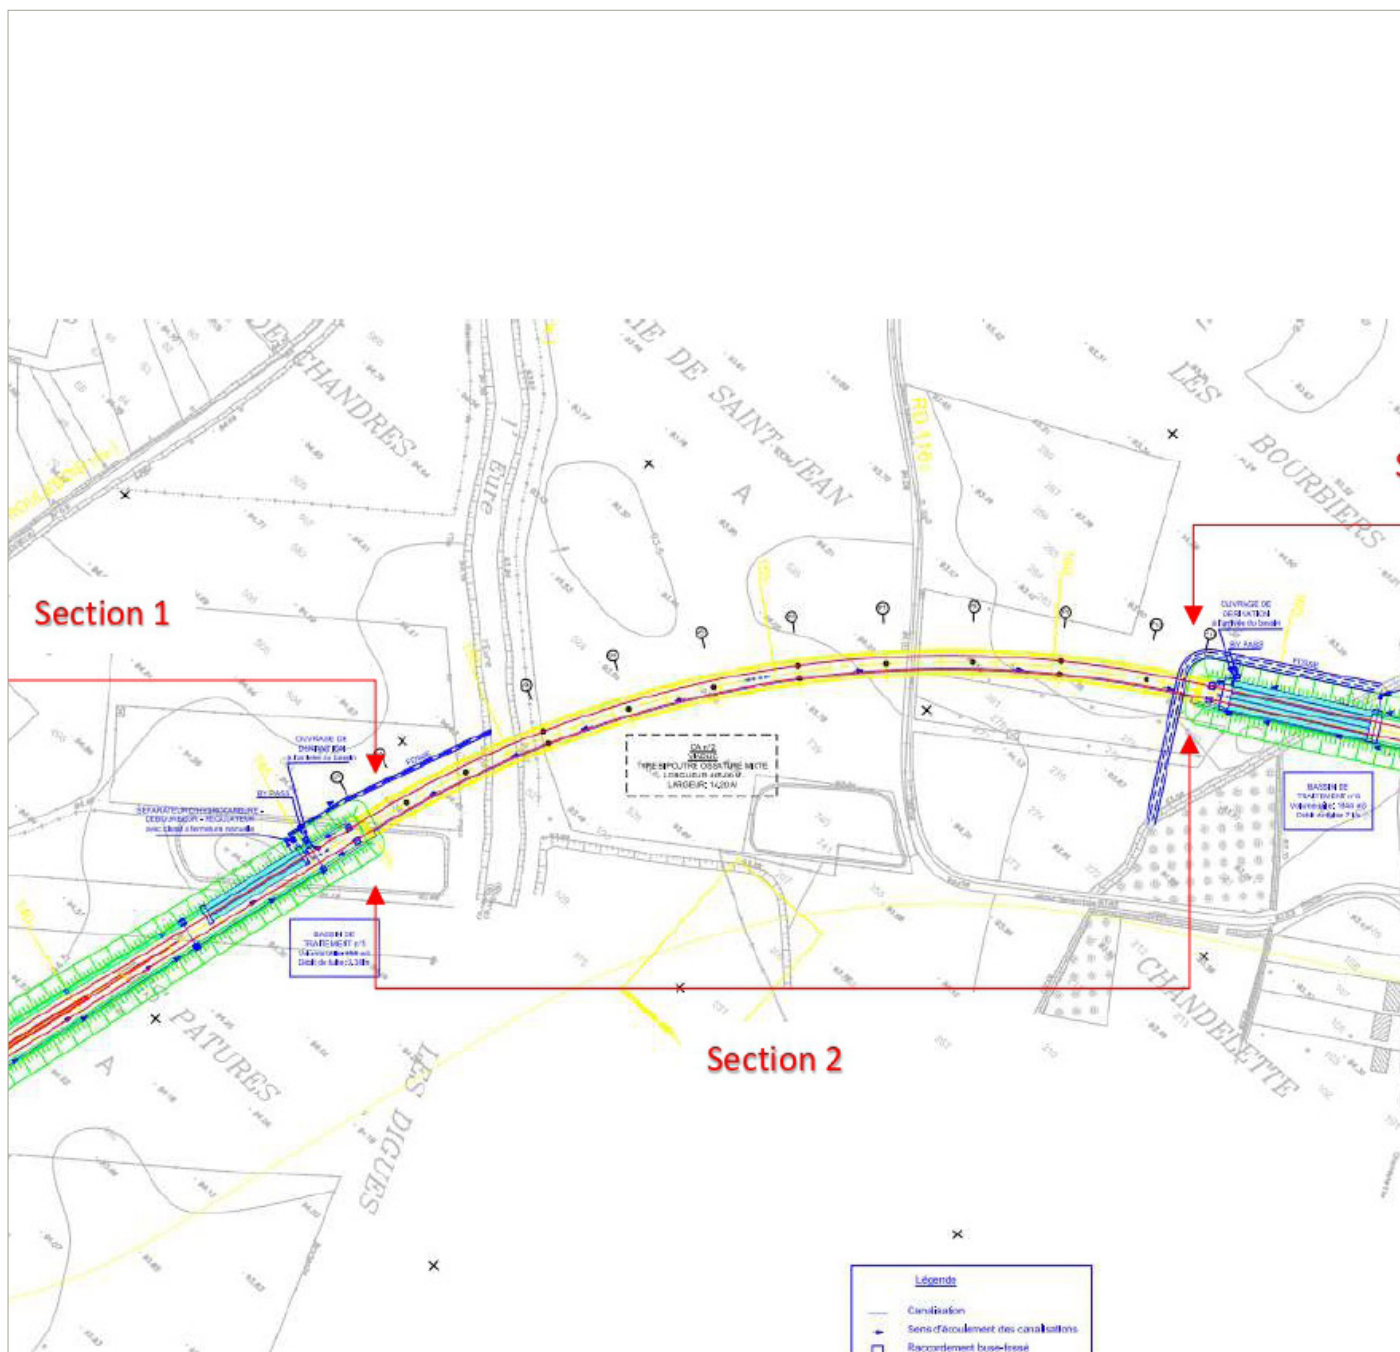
Extrait du plan du projet du franchissement de la vallée de l'Eure de 2006 entre la RD983 à l'ouest et la RD116a
